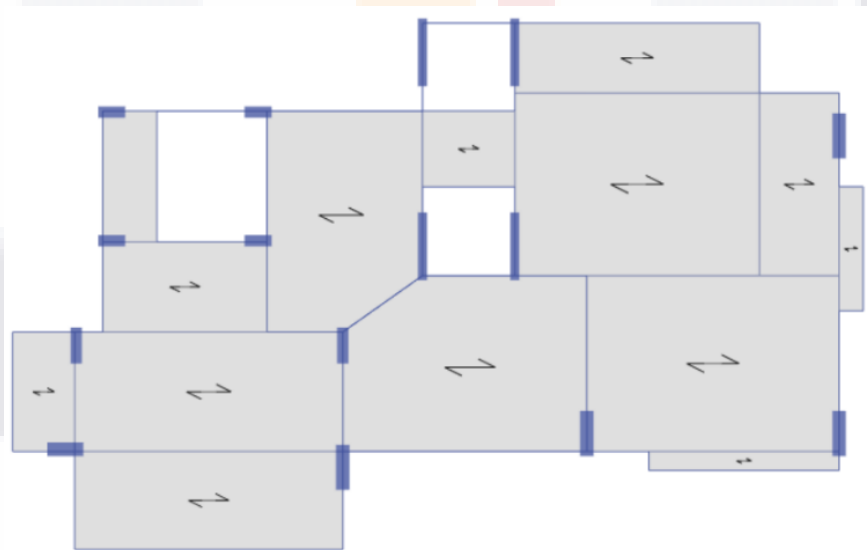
Columnas y vigas del piso “tipo” de la estructura original.
